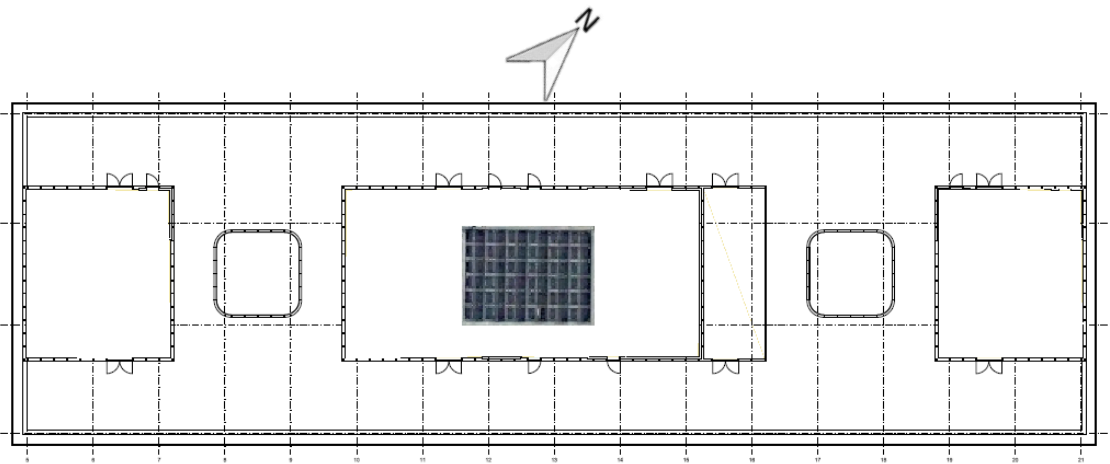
Plano de la distribución actual de la instalación fotovoltaica sobre la cubierta grande del hospital.
